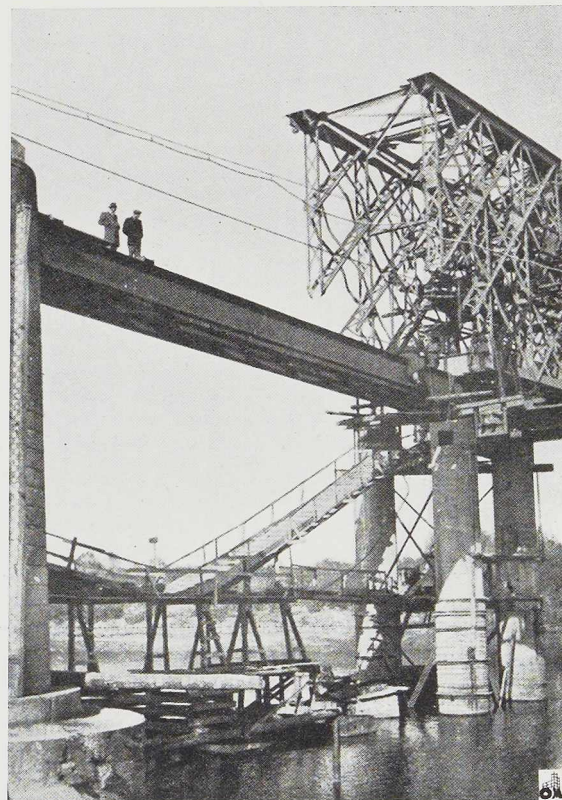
Vue du poutrellage réunissant les deux tours en béton armé.
